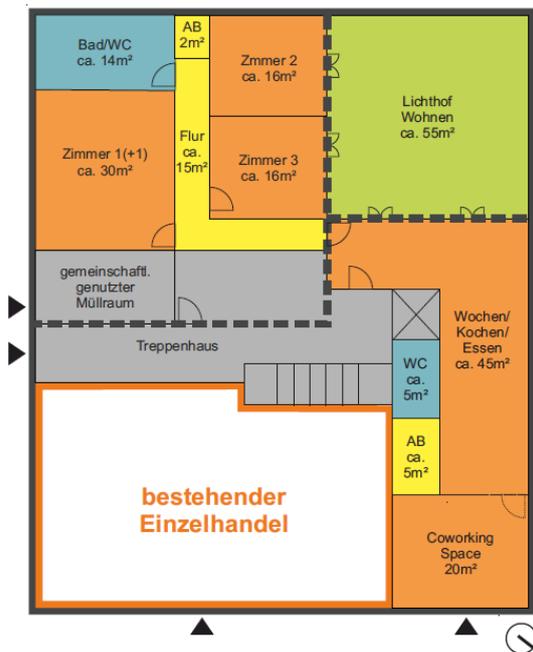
Grundrisskonzept "experimentelles Wohnen"
